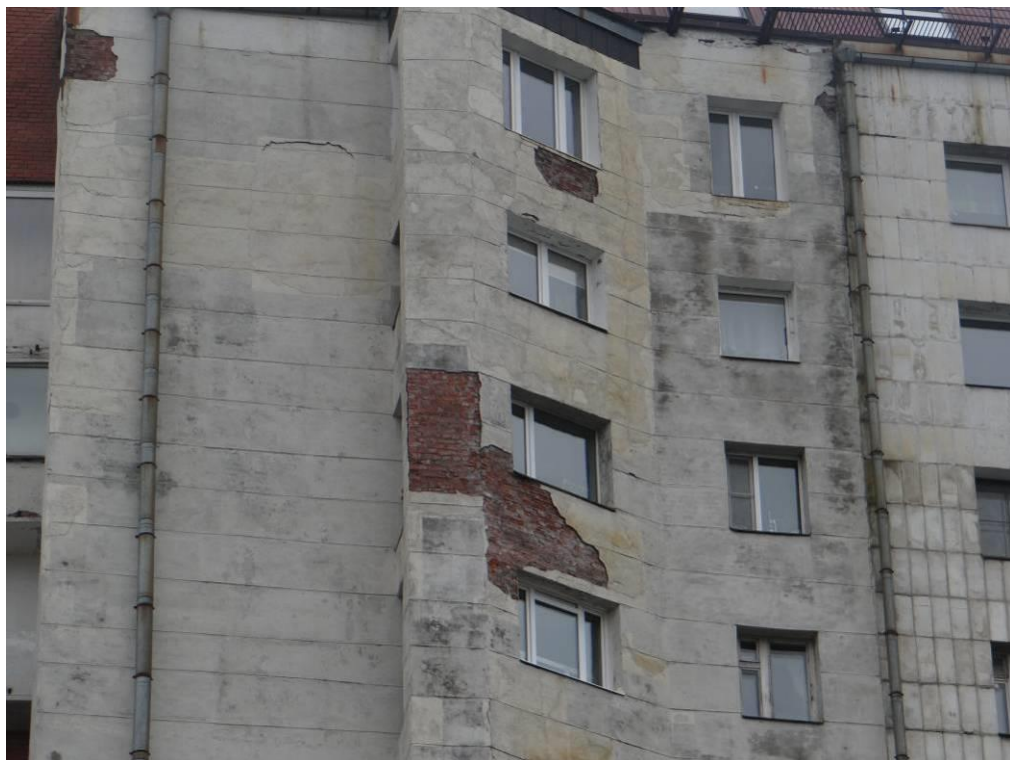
Фрагмент фасада по оси «Б» на участке в осях «17» - «18» в уровне 11-13 этажей. Следы увлажнения поверхностей фасада, приуроченные к кровельному свесу и элементам системы водостока. Сети разнонаправленных трещин в штукатурном покрытии. Участки обрушения штукатурного покрытия. Морозное разрушение материалов кирпичной кладки.
